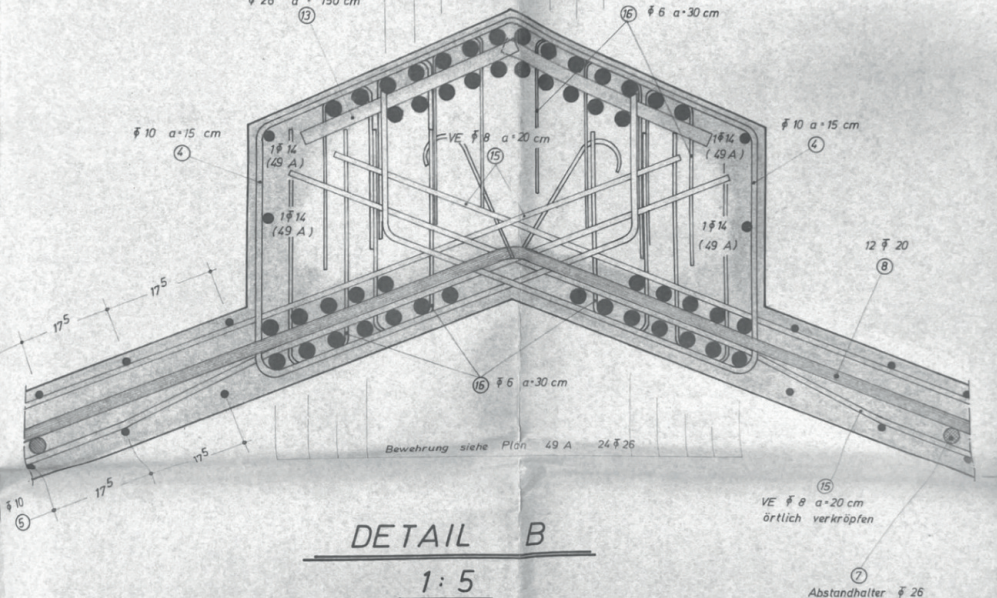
Querschnitt Bewehrung Firstpunkt 1969
